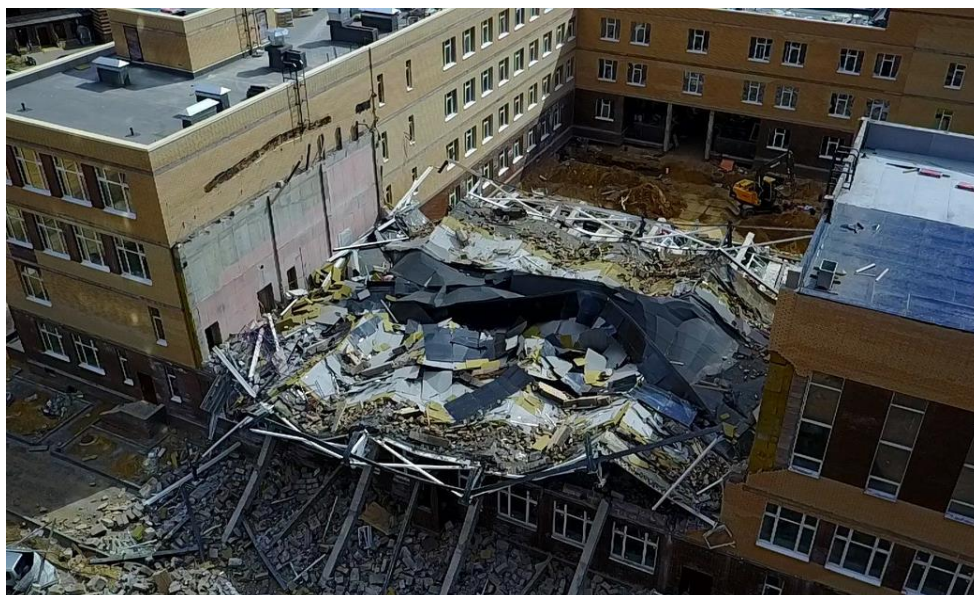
Разрушение строительных конструкций в зоне спортзала
